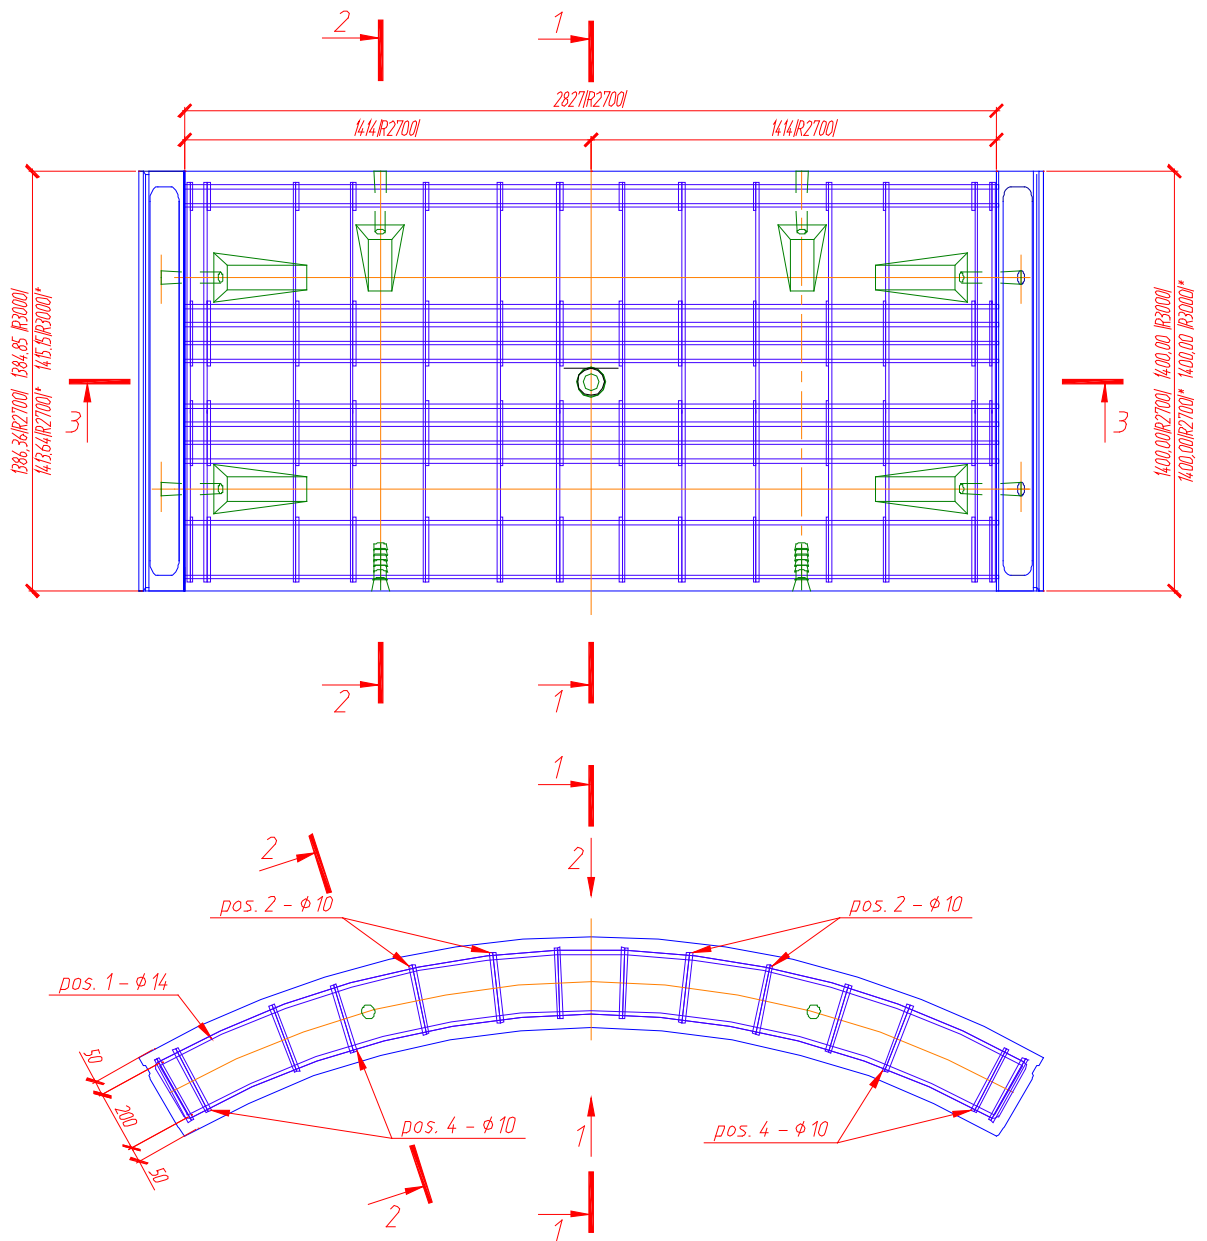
Схема армирования блока стеклопластиковой арматурой.
